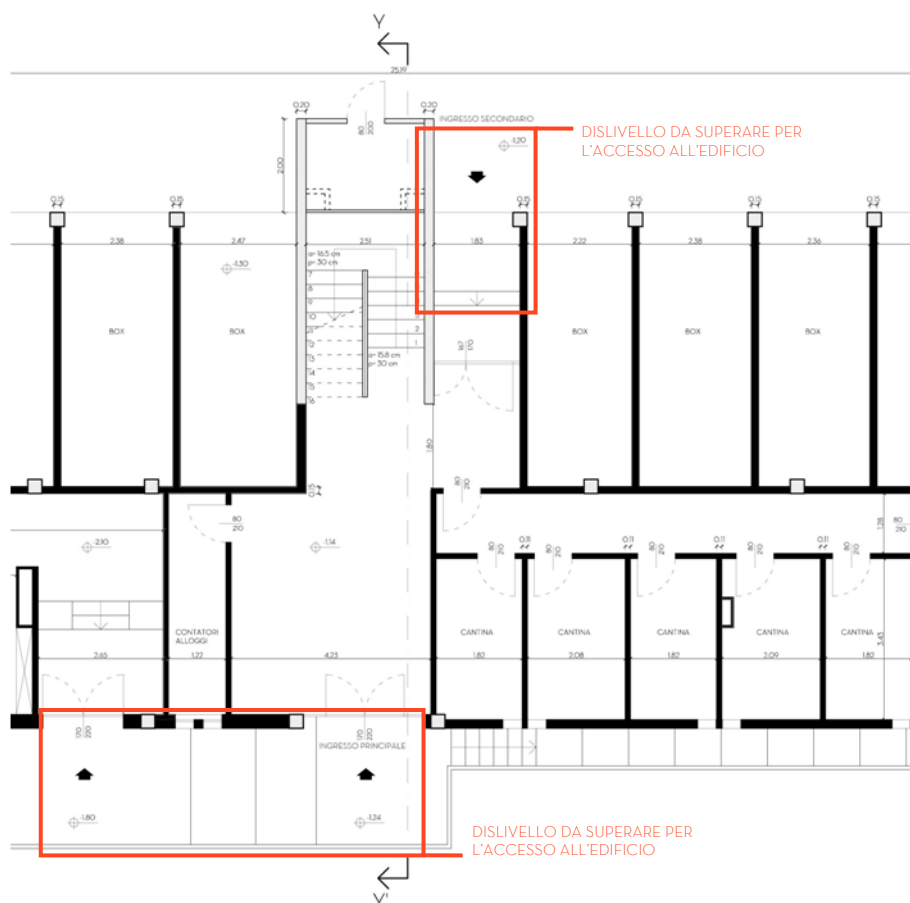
, Porzione Pianta Piano terra con vista degli ingressi. Tavola SF 13
